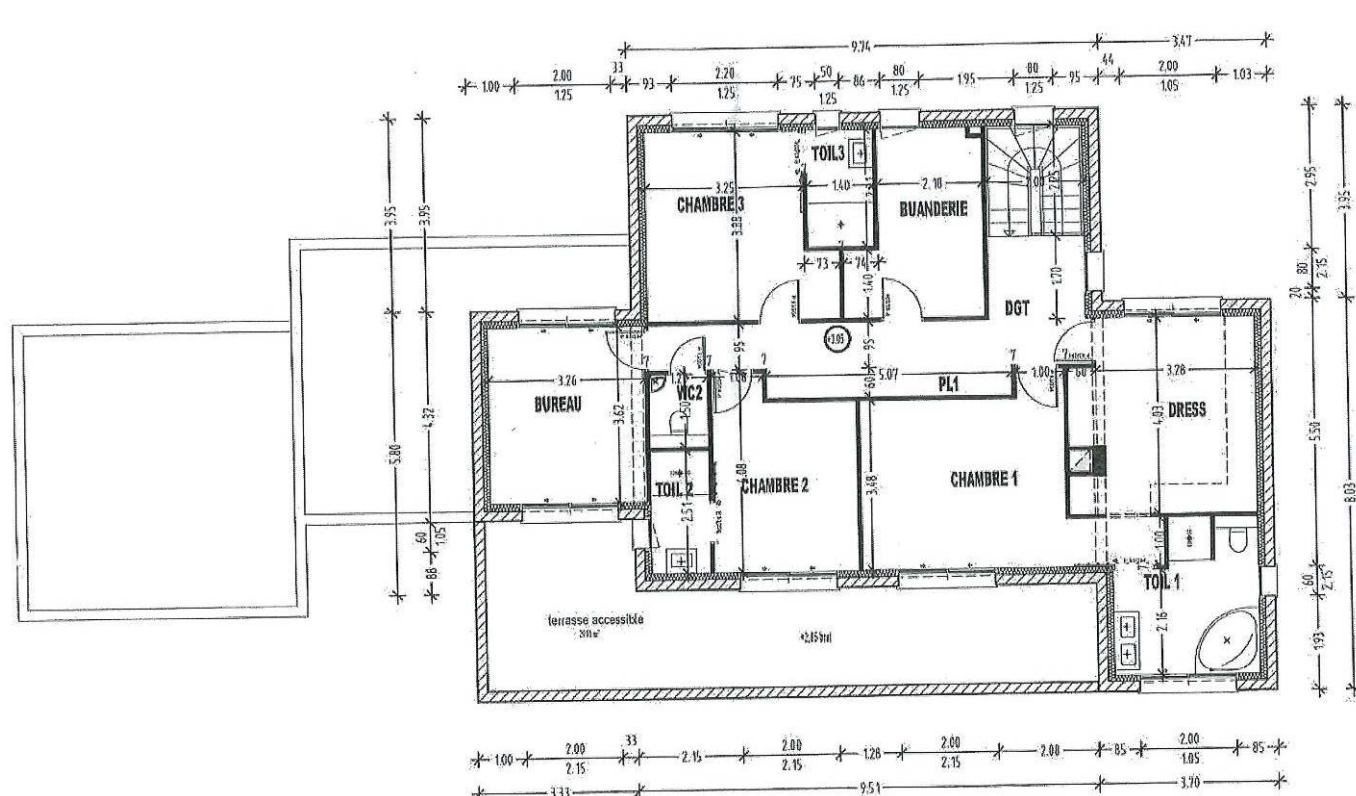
Exemple de plan reçu en accompagnement de la fiche de projet. Privilégier les formats AutoCAD
